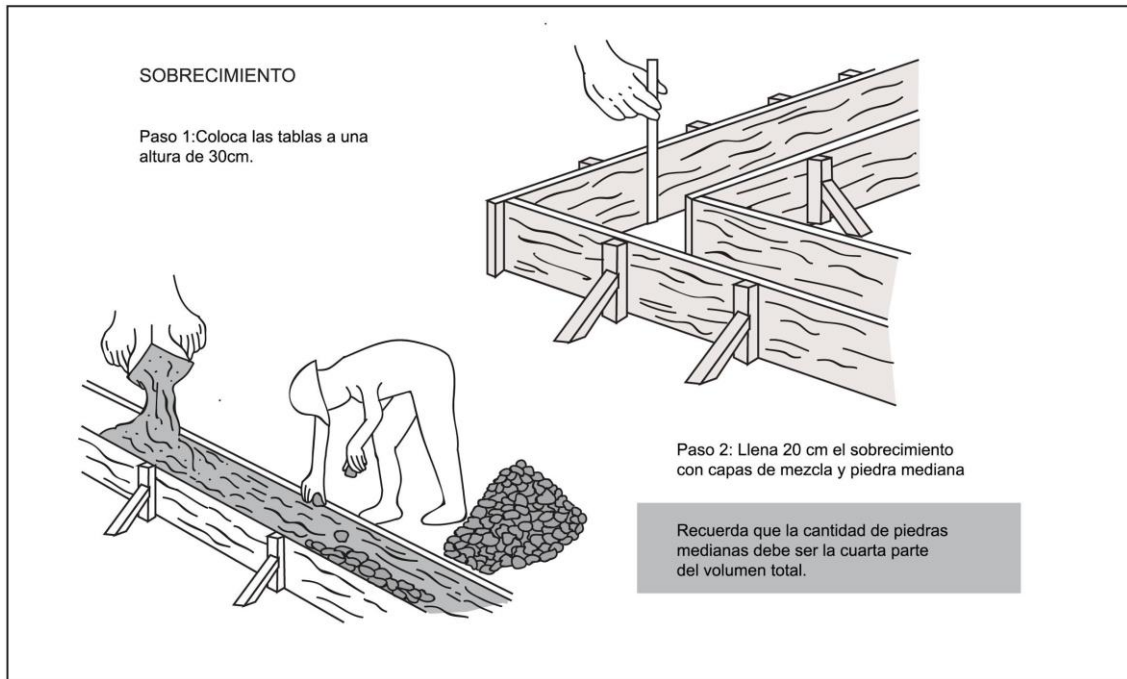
Sobrecimiento. Fuente (Valvivia, 2016)
